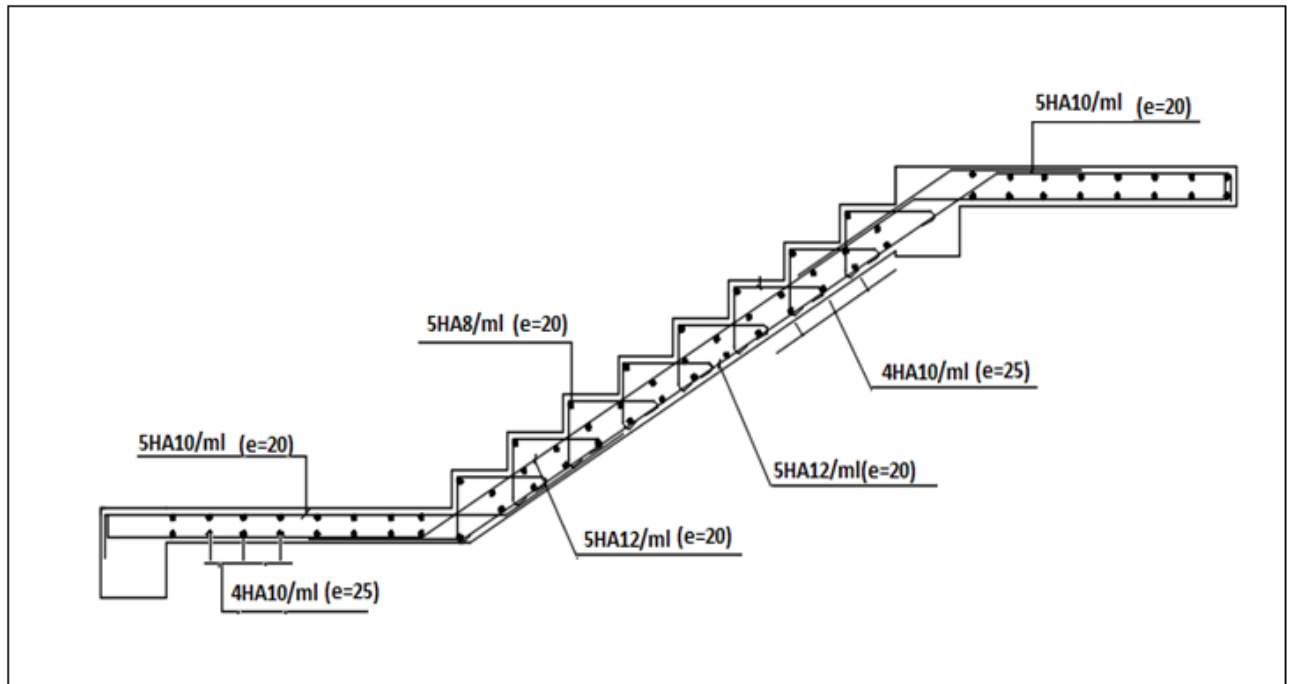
Plan de ferrailage des escaliers.
